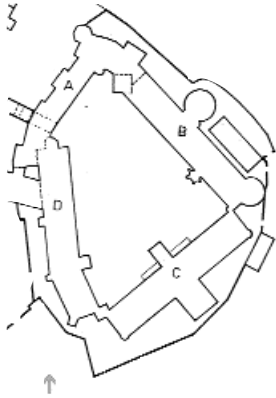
Torgau, Schloß Hartenfels, Grundrißschema (mit Buchstabenbezeichnung)
